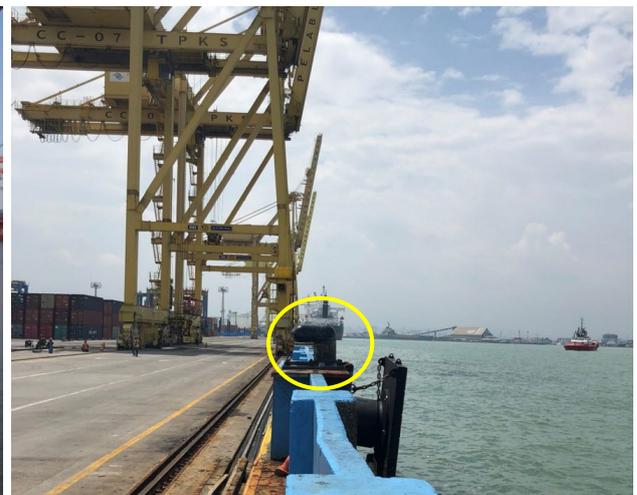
タンジュンエマス港での防潮壁設置状況事例
